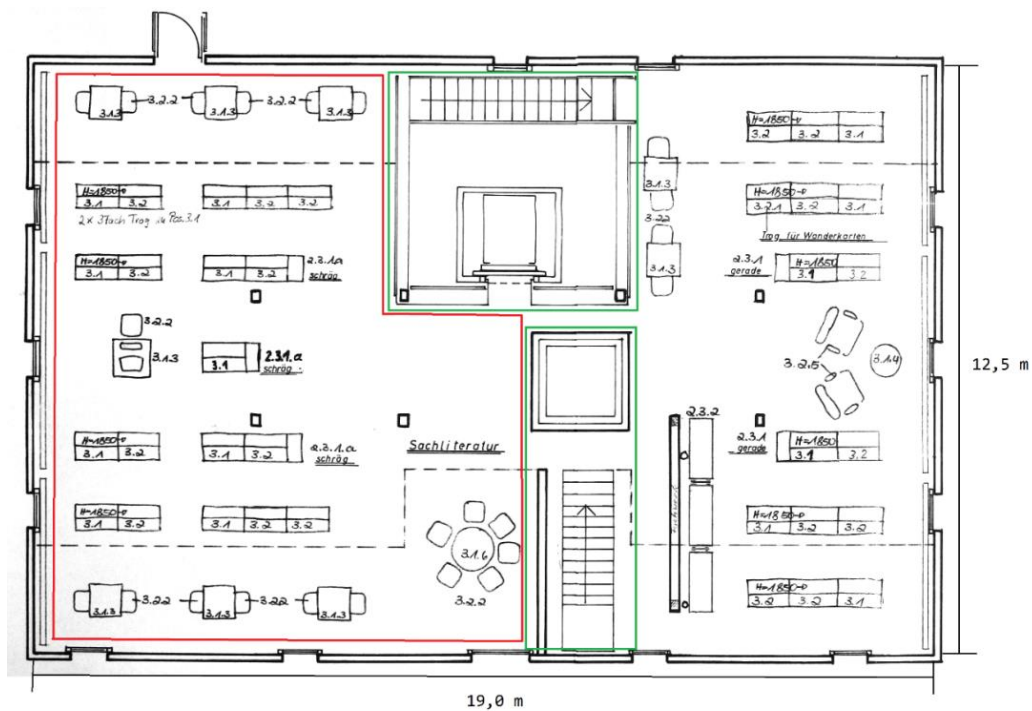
Grundriss des 2. OGs mit Markierung des zukünftigen Lernbereichs
